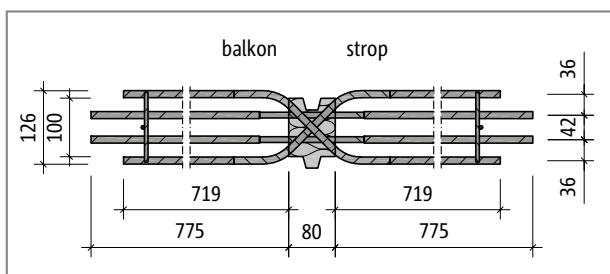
Schöck Isokorb® tip EQS: prerez proizvoda
